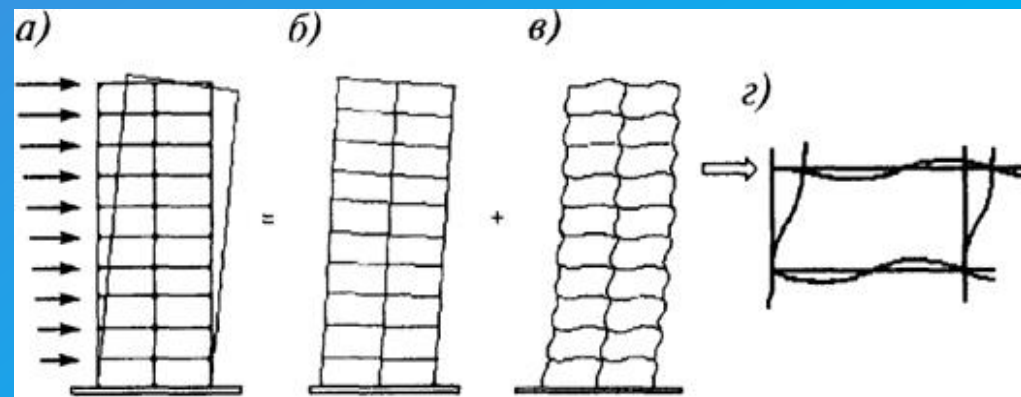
Схеми деформування каркаса з рамними вузлами при дії горизонтального навантаження:
